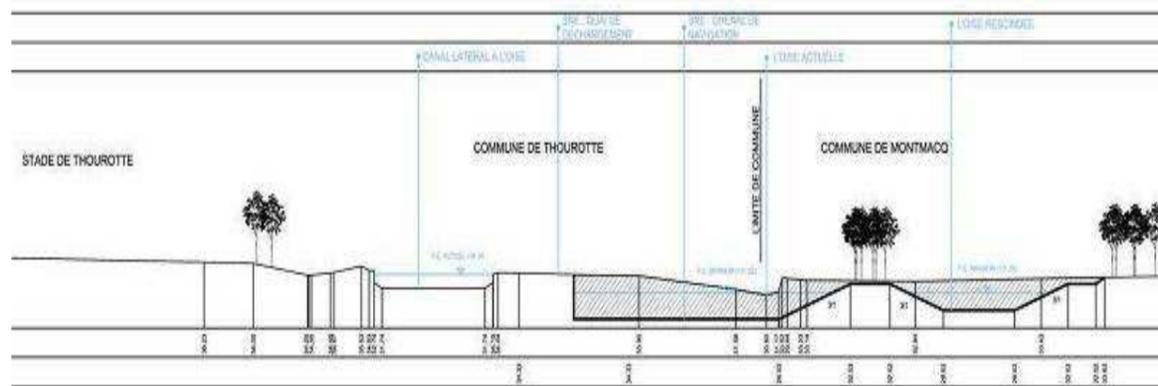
Vue en coupe du tracé en site propre (source : CNR)
